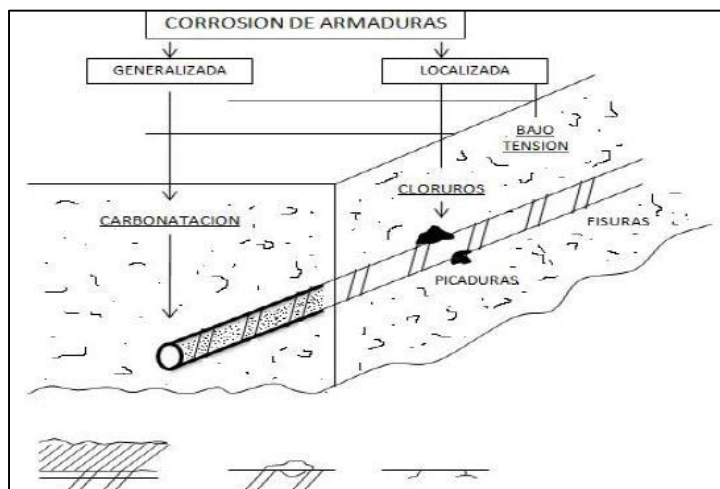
Tipos de corrosión de armaduras de concreto
